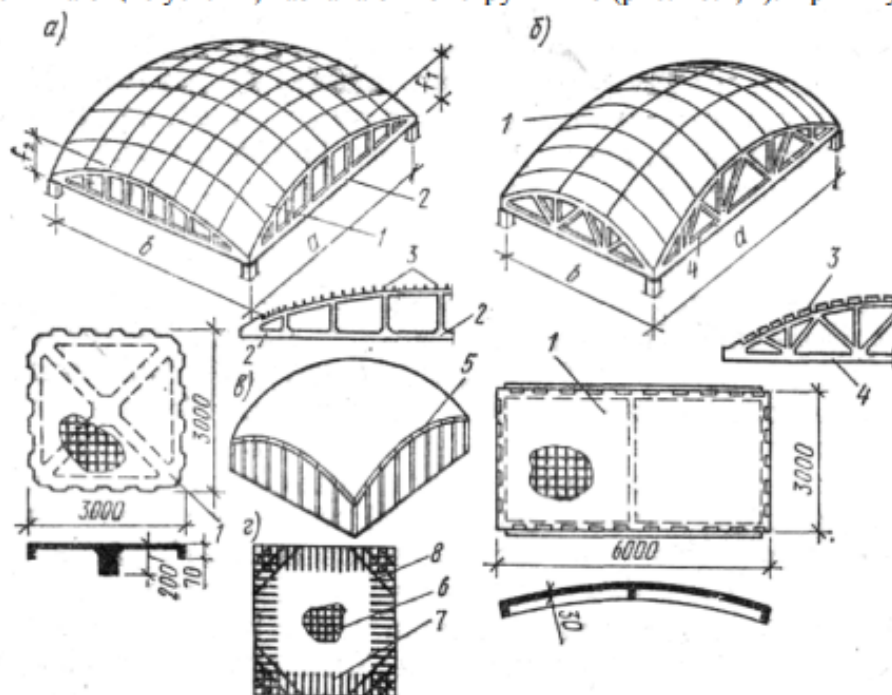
Конструктивные решения пологих сборных оболочек положительной гауссовой кривизны на прямоугольном плане (а..в); схема армирования монолитной оболочки (г):
